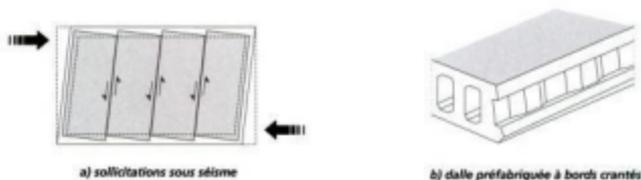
Diaphragme en dalles préfabriquées.
